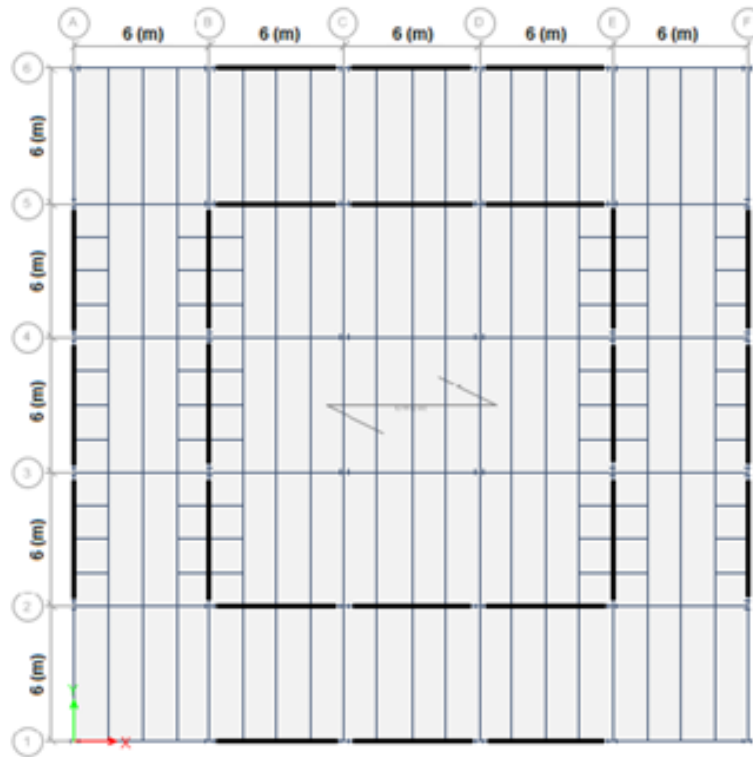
Vista en planta de la única variante para la edificación de 10 niveles.
